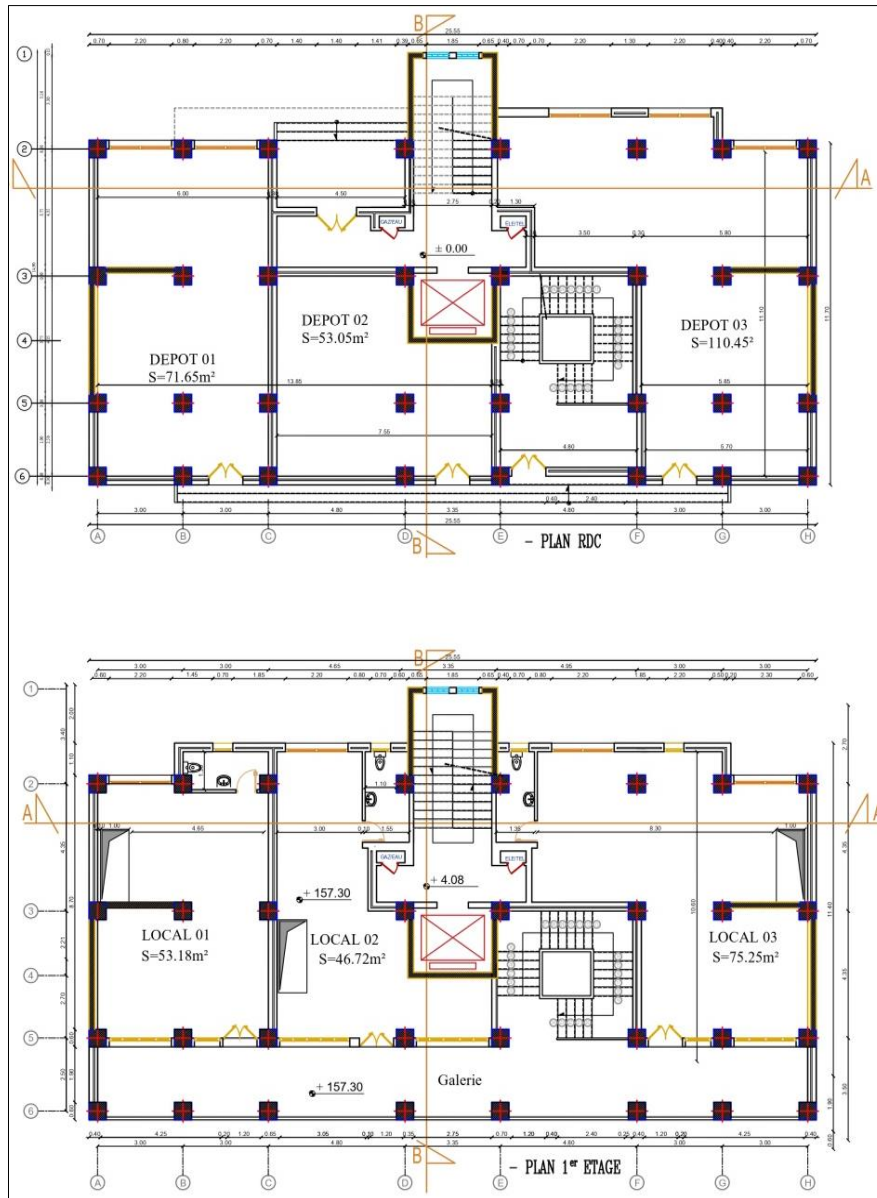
Vues en plan (plan RDC et plan 1er étage)
